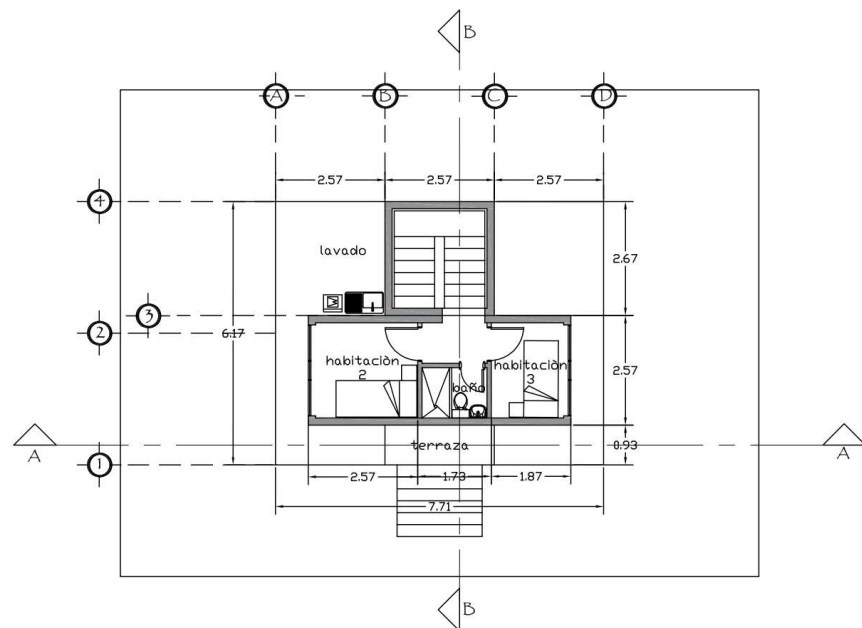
Planta Segundo Nivel Tipología - A - Elaboración propia
